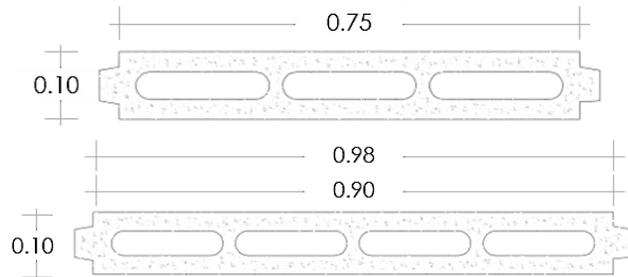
Geometría y dimensiones de las unidades de bloque panel. Fuente: Manual Técnico Sistema Constructivo Bloque Panel.
